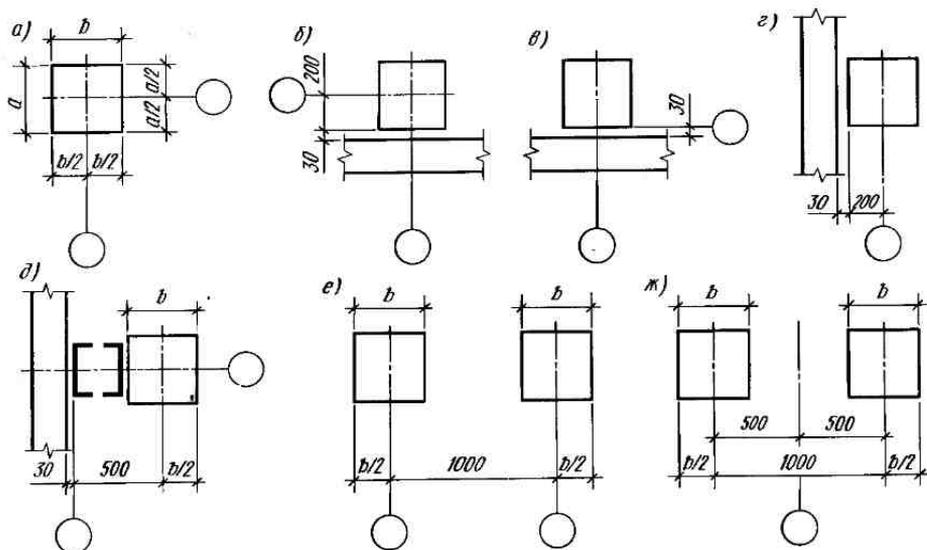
Привязка колонн и стен многоэтажных зданий к координационным осям:
